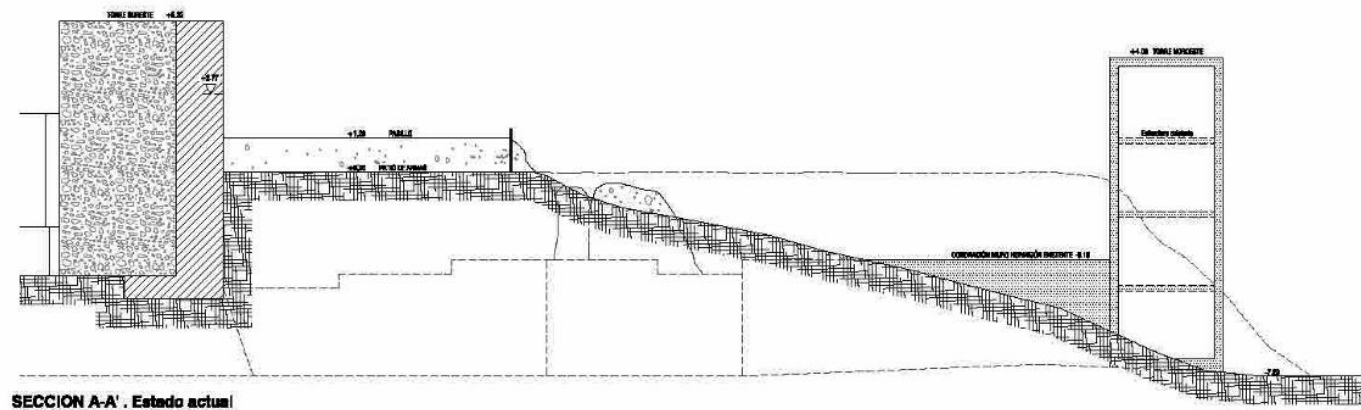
Sección transversal del talud entre las torres Noroeste y Norte. Estado actual.
